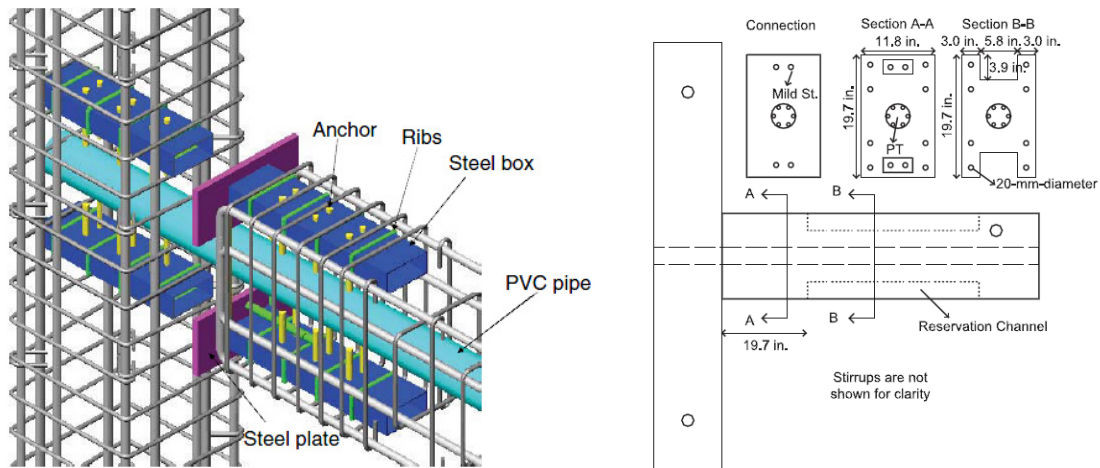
Representação da ligação viga pilar ensaiada por Ozden e Ertas (2007) (adaptado)
